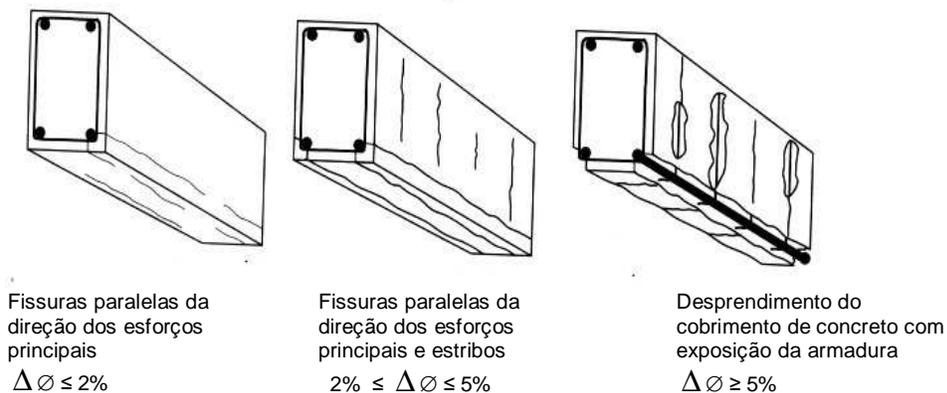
Representação esquemática das patologias tipicamente observadas em vigas de concreto afetadas por corrosão (HELENE, 2003).
